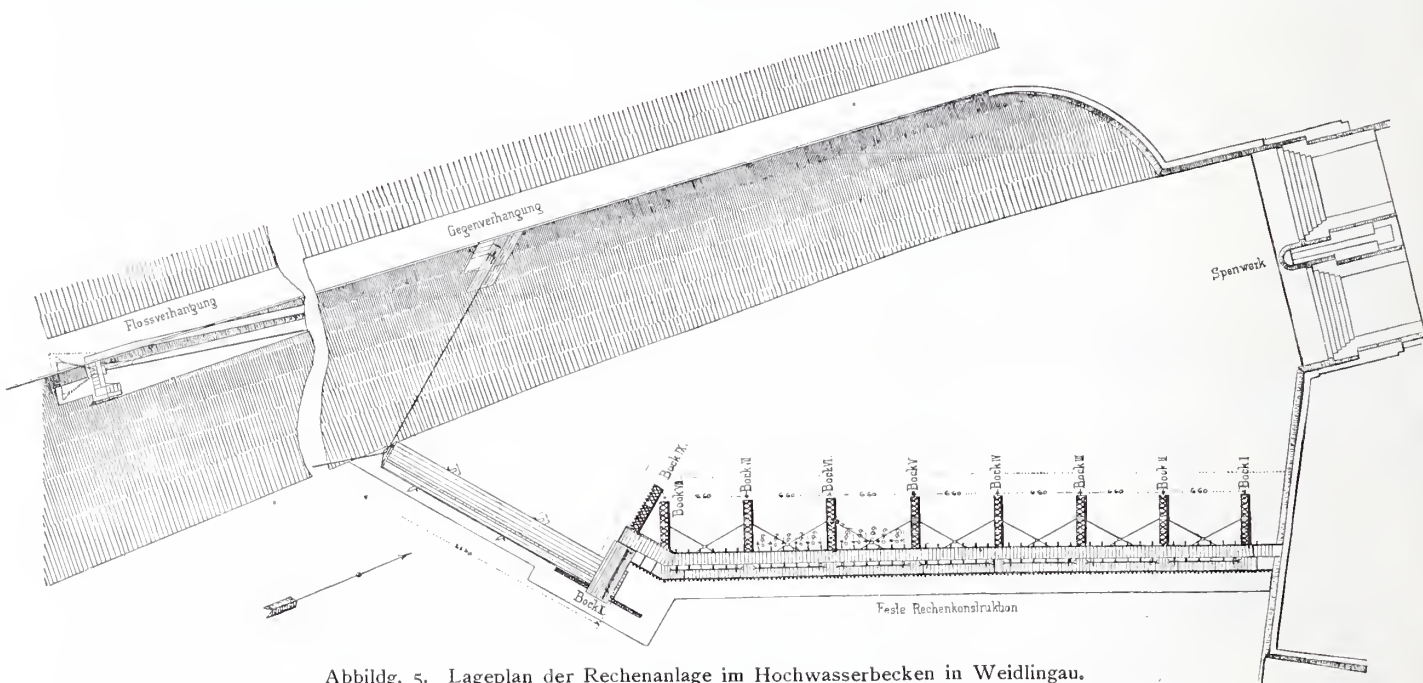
Lageplan der Rechenanlage im Hochwasserbecken in Weidlingau.
